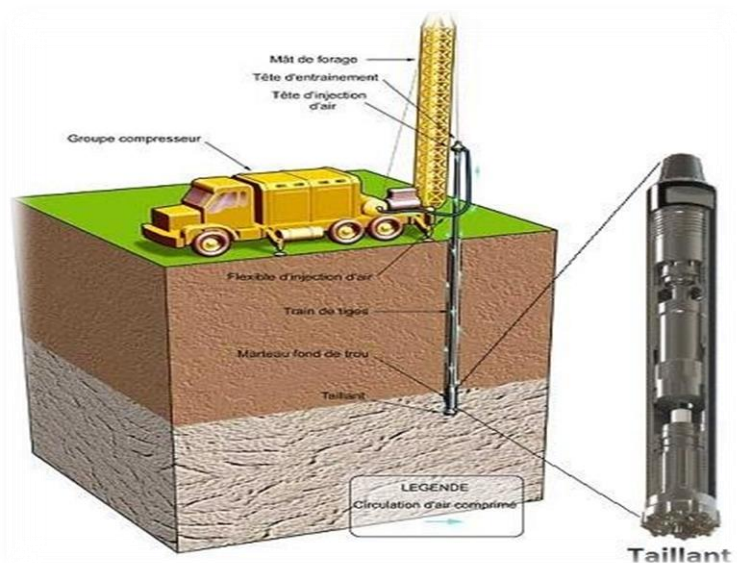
Schéma simplifié d'une installation de forage marteau fond de trou (MFT)
